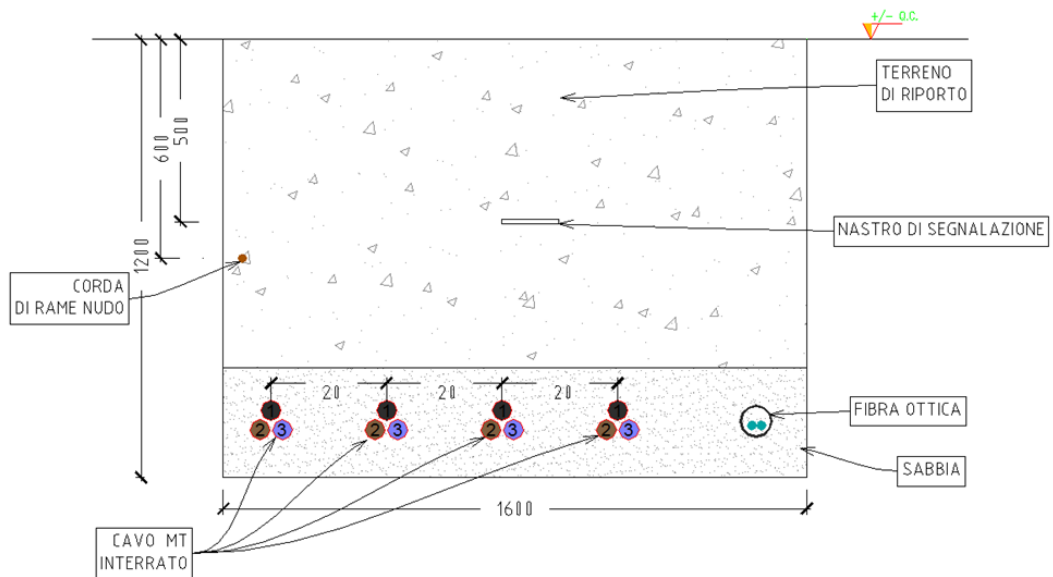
Sezione tipo posa cavo MT con n° 4 linee
